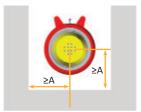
Representação do macaco posicionado na estrutura - VISTA FRONTAL
